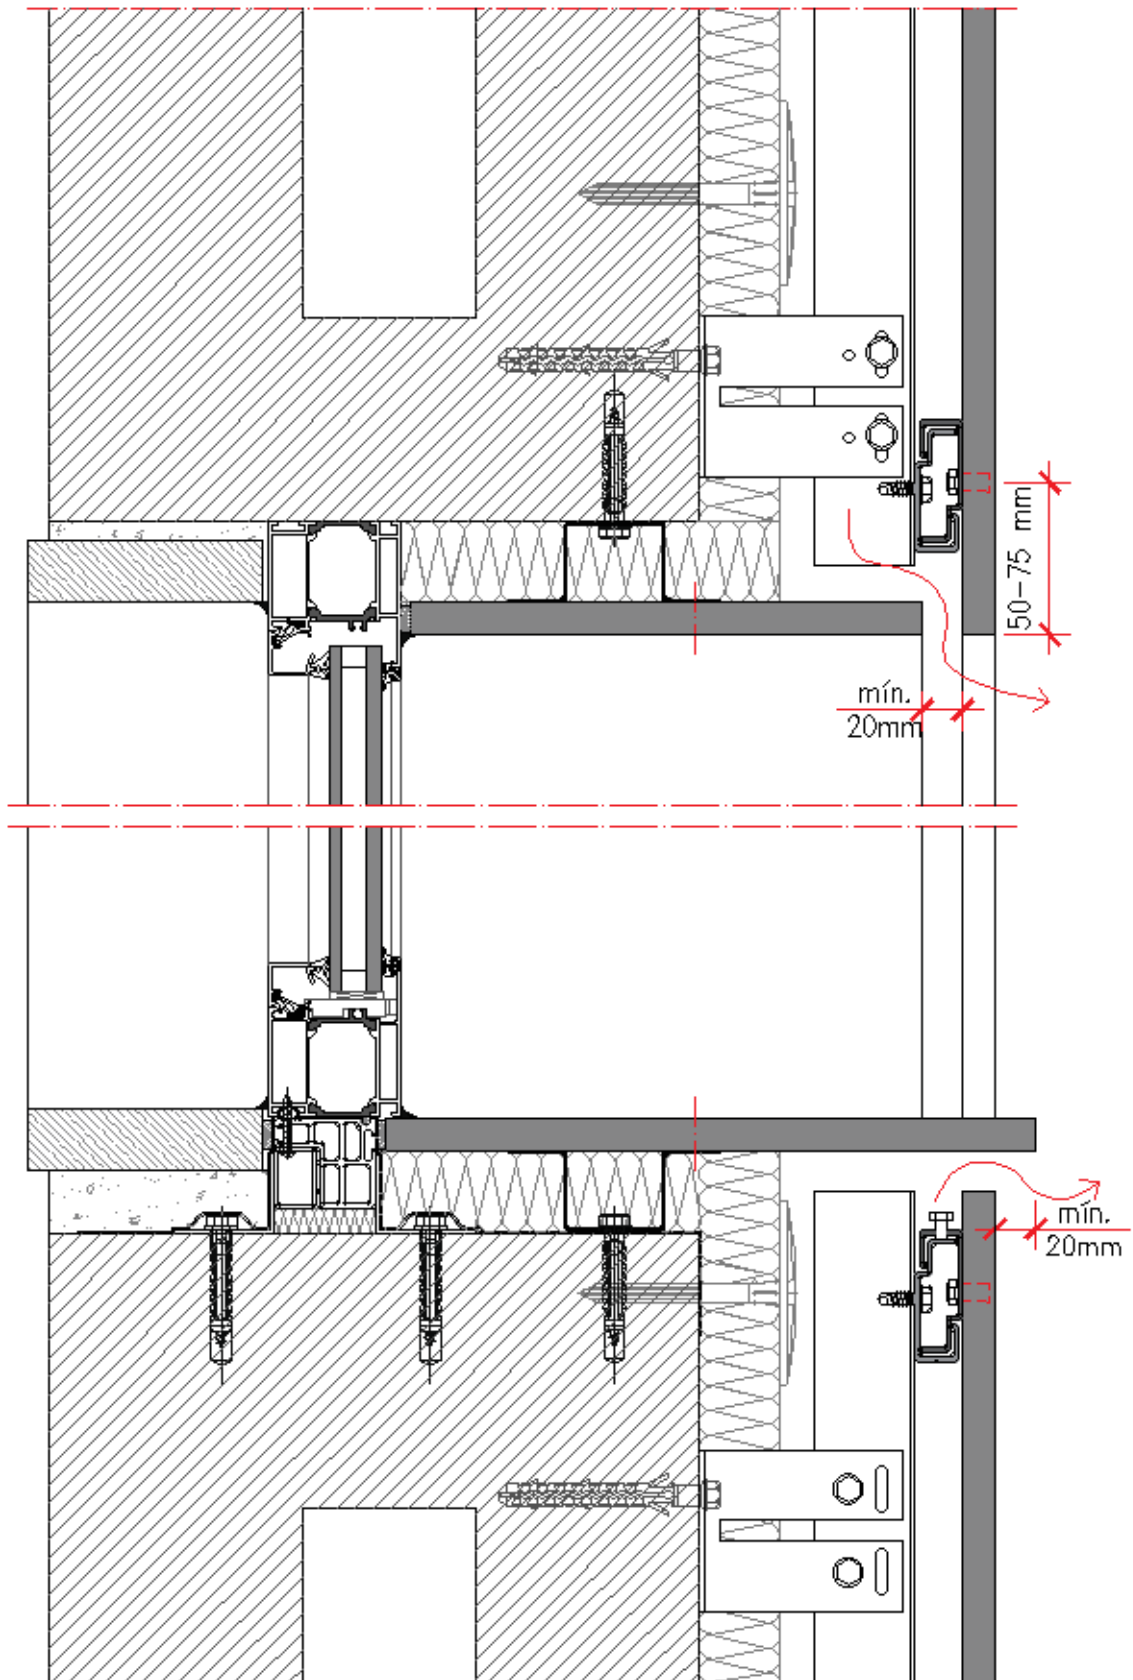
Pormenor do vão de janela, corte vertical
